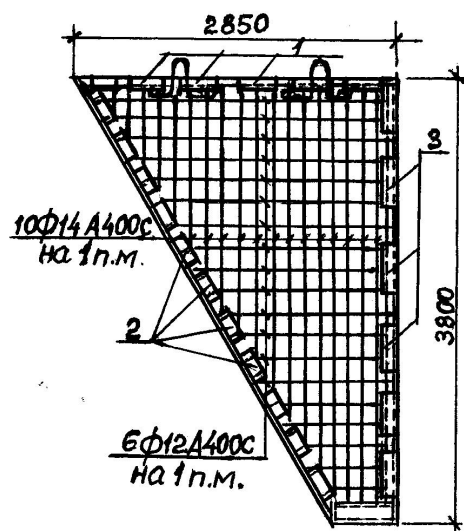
Армирование плиты воронки (верхняя арматура):
